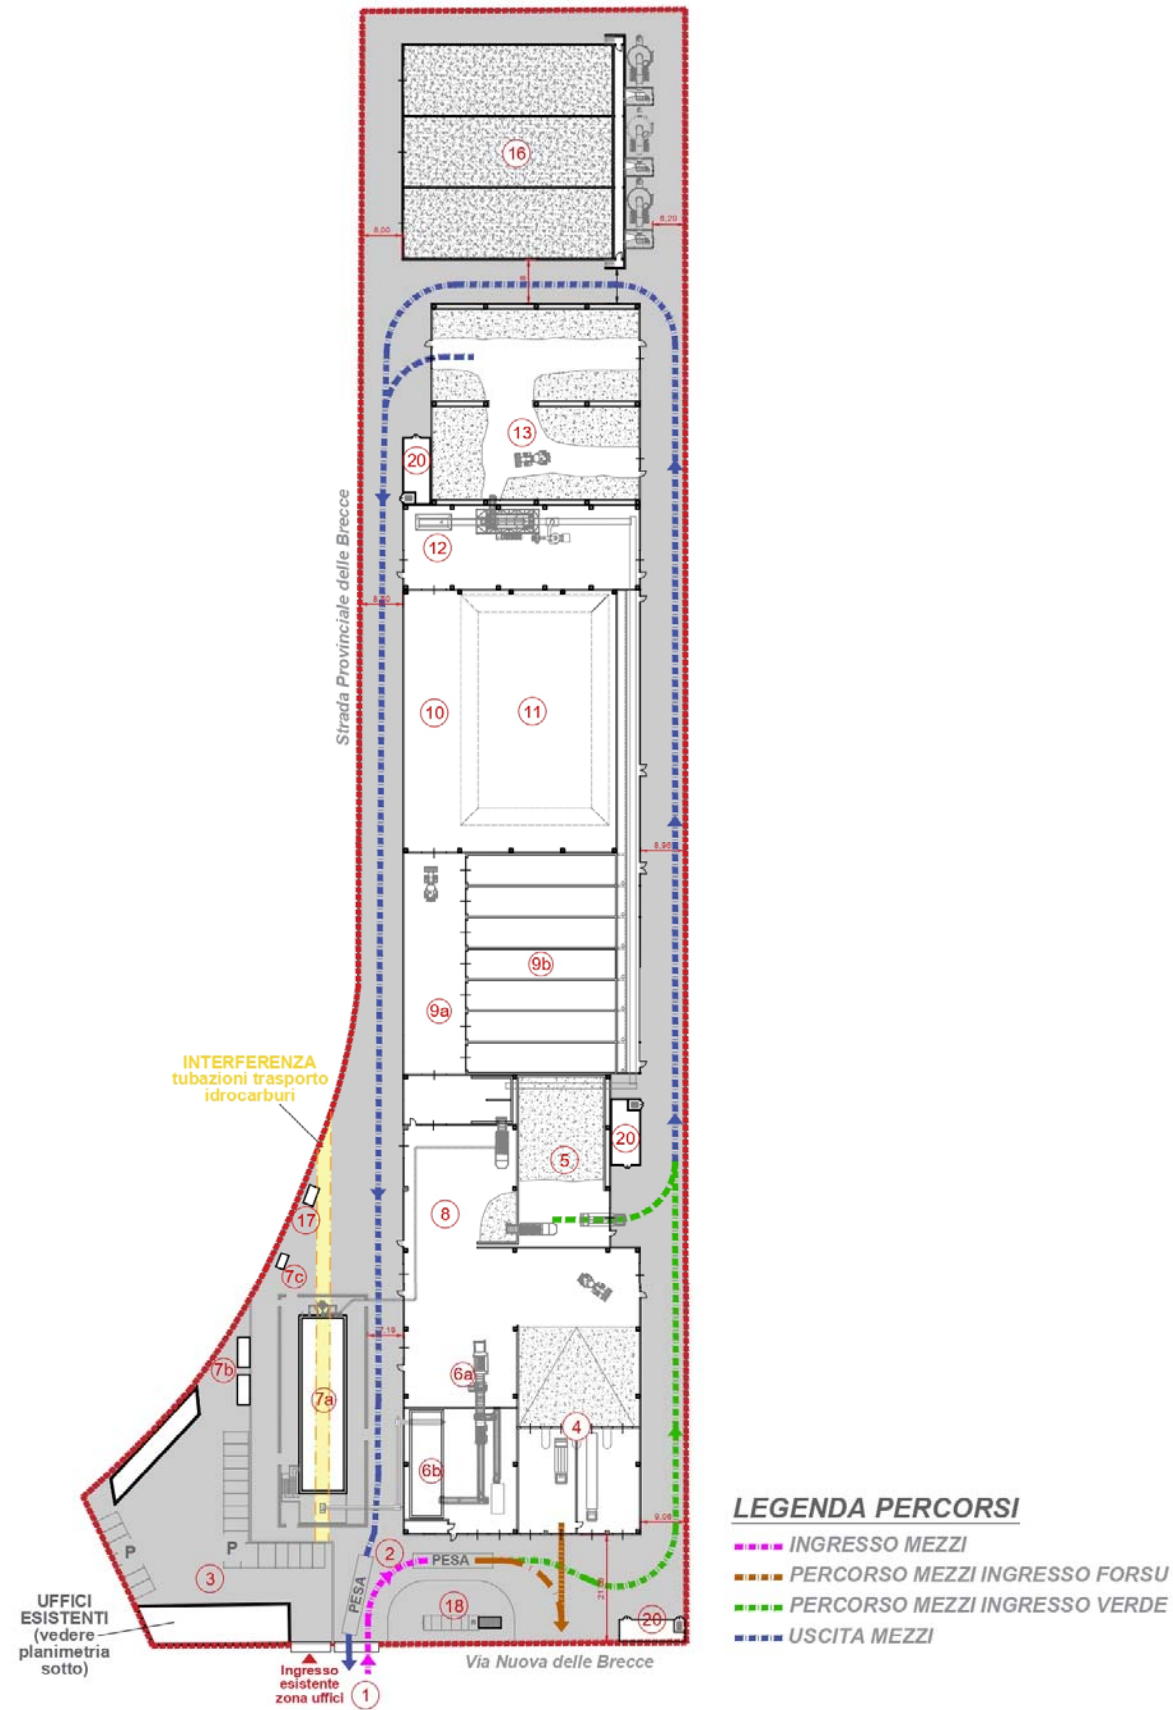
Layout di Progetto – Area Alternativa B – Pianta attacco a terra
